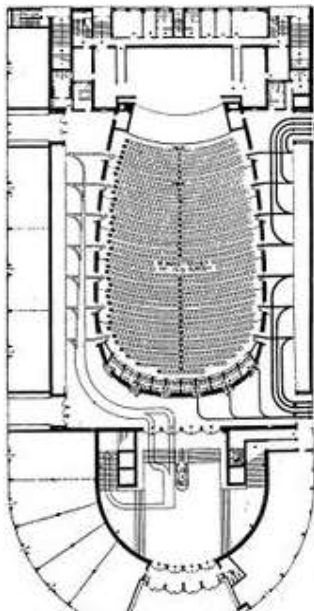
Planta baja Cine Universum, Mendelsohn, 1928
